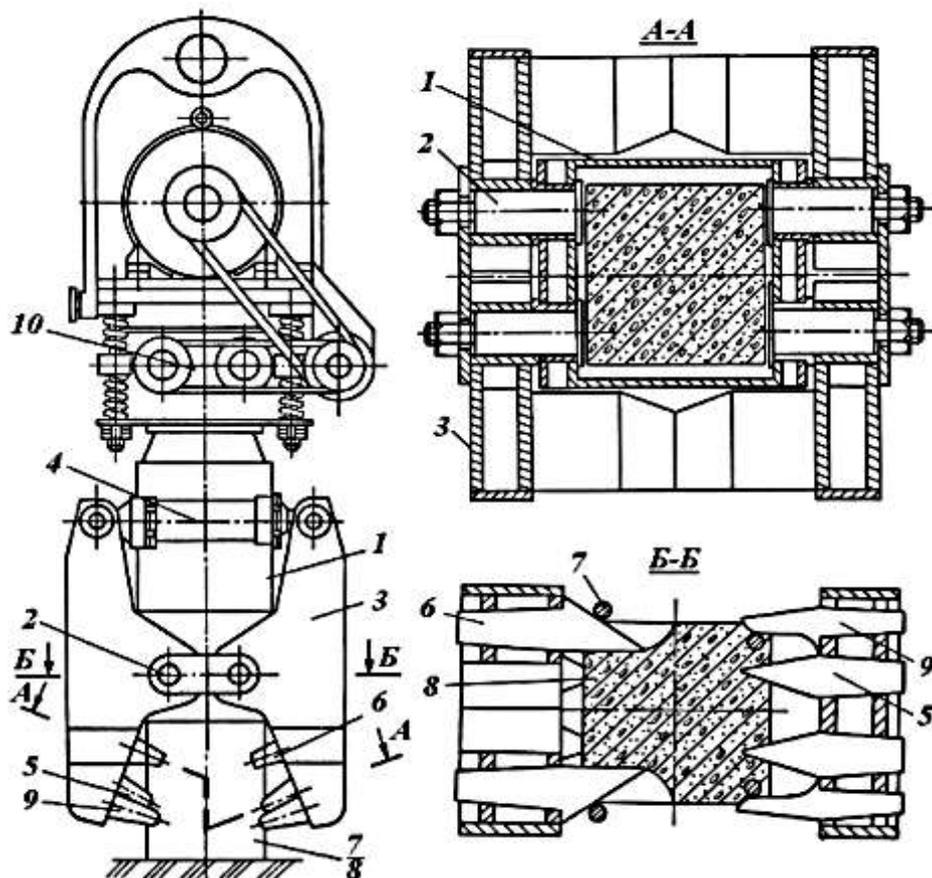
Устройство для срезки свай с сохранением арматуры над срезом.
